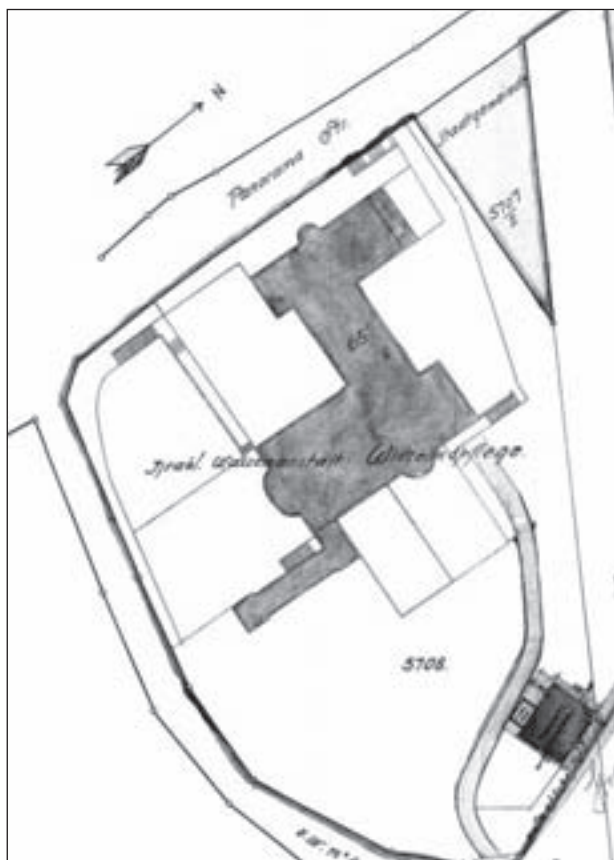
Esslingen, ehem. israelitisches Waisenhaus Wilhelmspflege, Lageplan 1917; *Die Bauwelt* 1916
